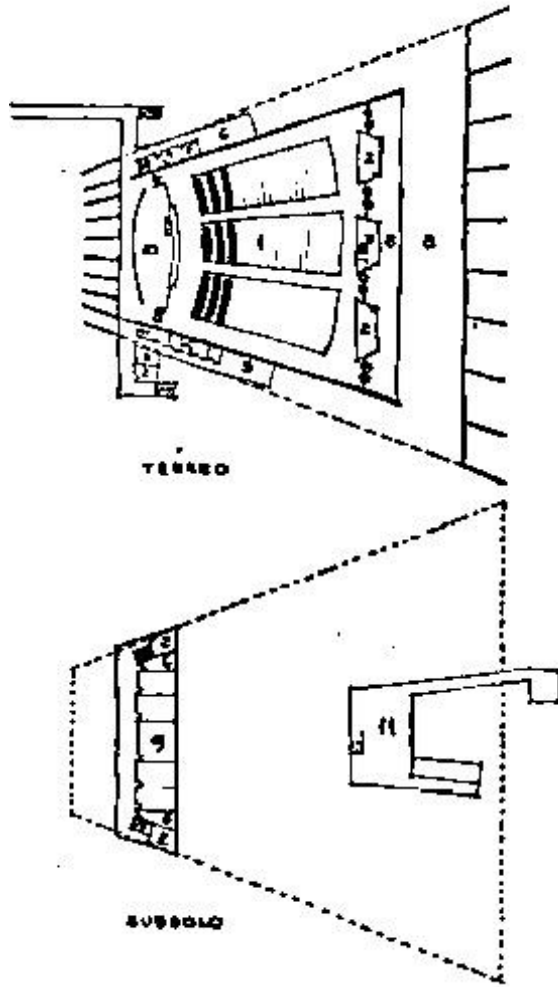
Planta baixa do térreo e do subsolo do Auditório Pedro Calmon. Fonte: Silva (2008:54).
